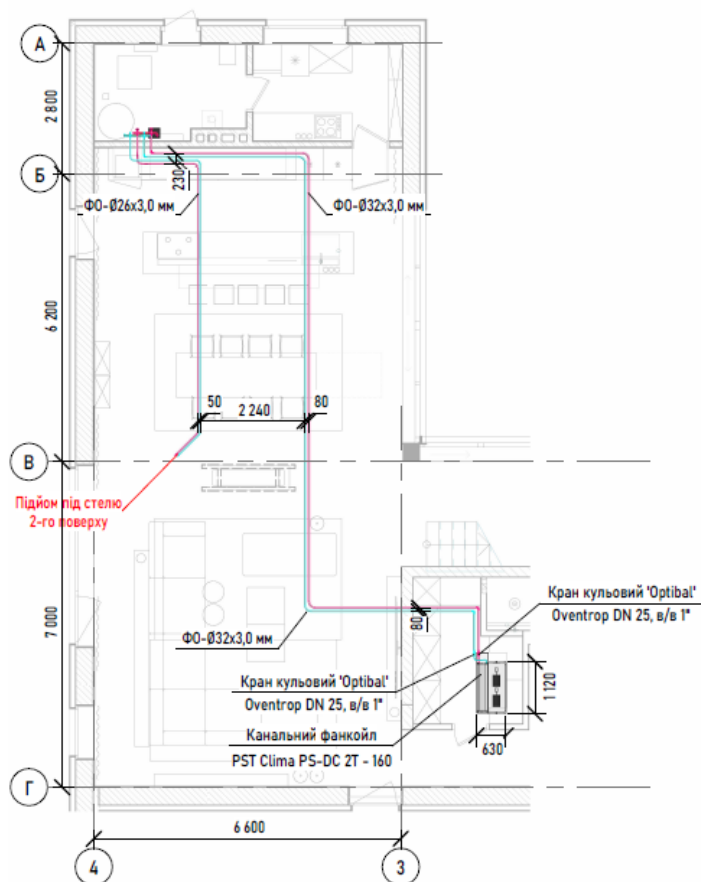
система холодопостачання фанкойлів, план 1-го поверху
